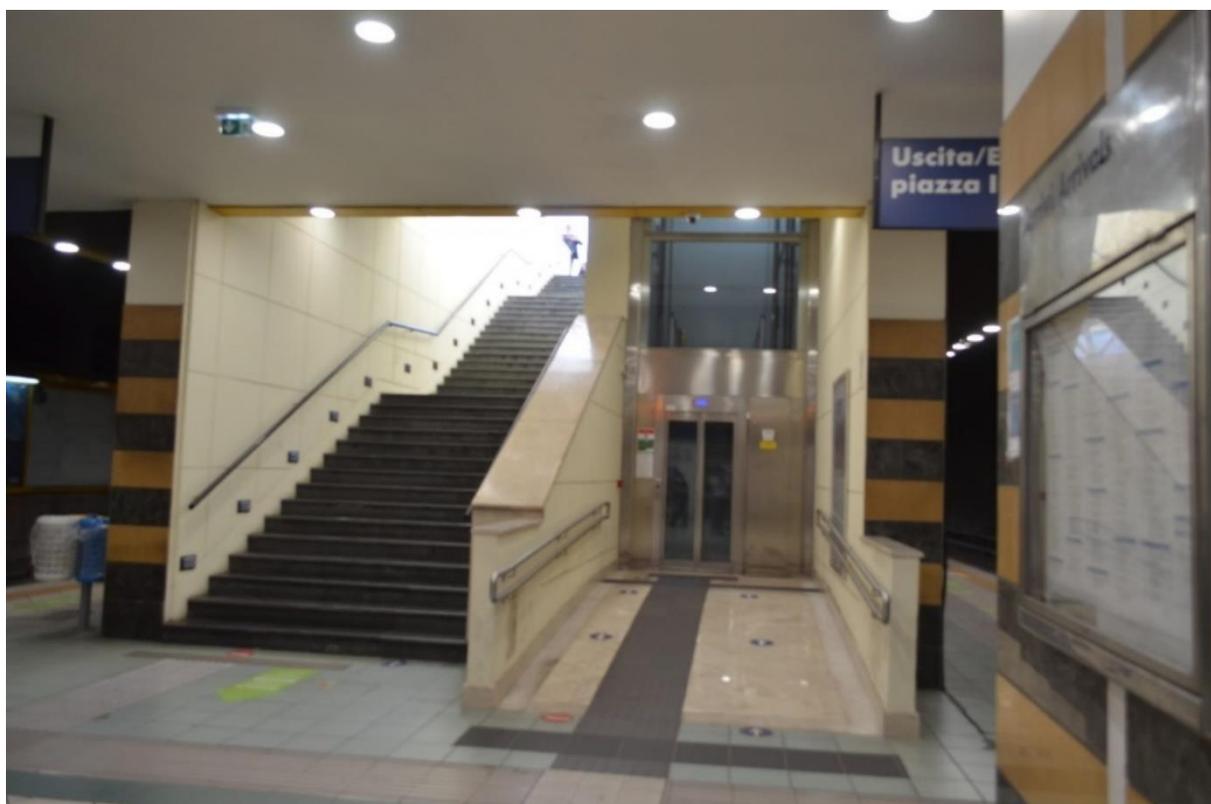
Scale ed ascensori di collegamento con piano di banchina
